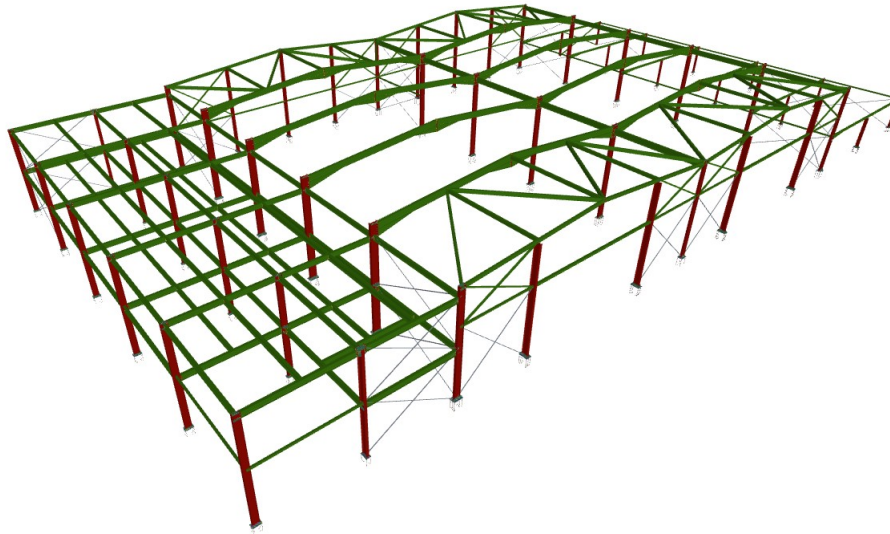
Modelo 3D de la estructura objeto del proyecto.
